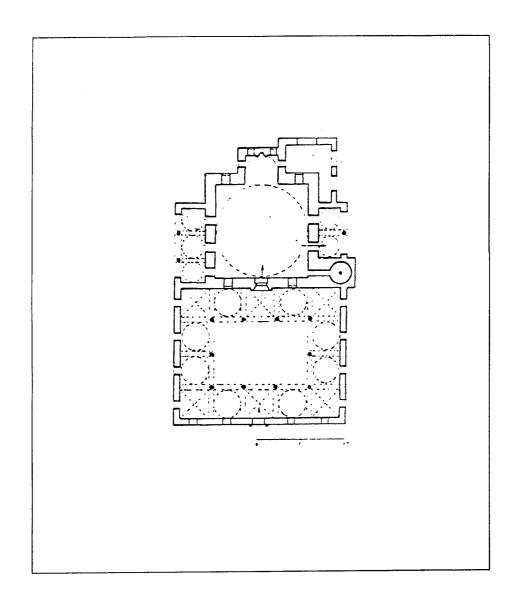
مسقط أفقي لمسجد لاله لى في استانبول (عن : جودوين) .
